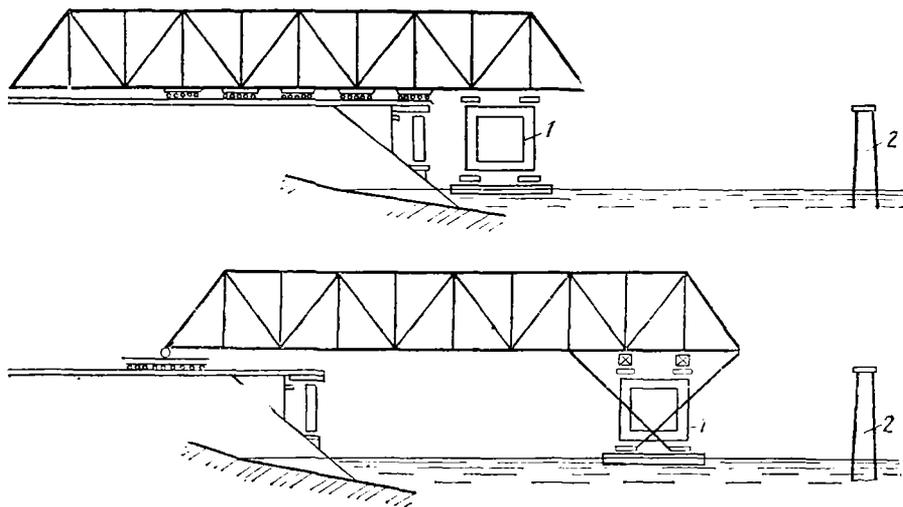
Схемы продольной передвижки с плавучей опорой (две рабочие позиции)
